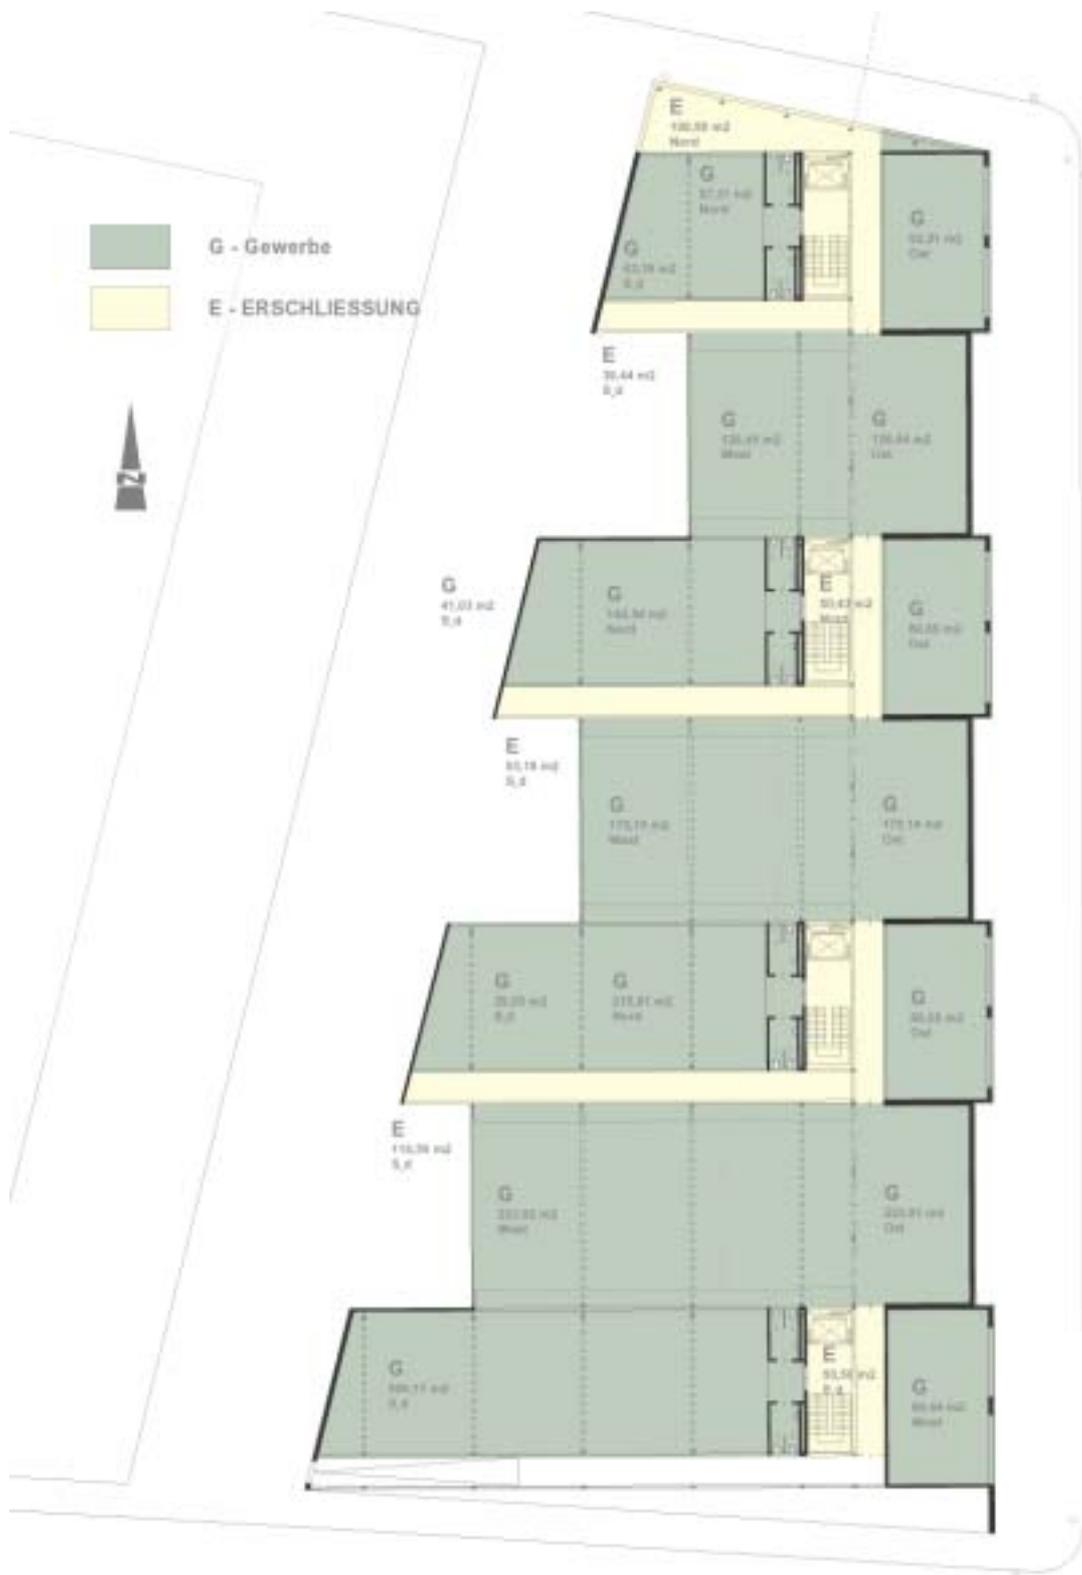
Mayssengasse, Grundriss EG, M = 1:500
